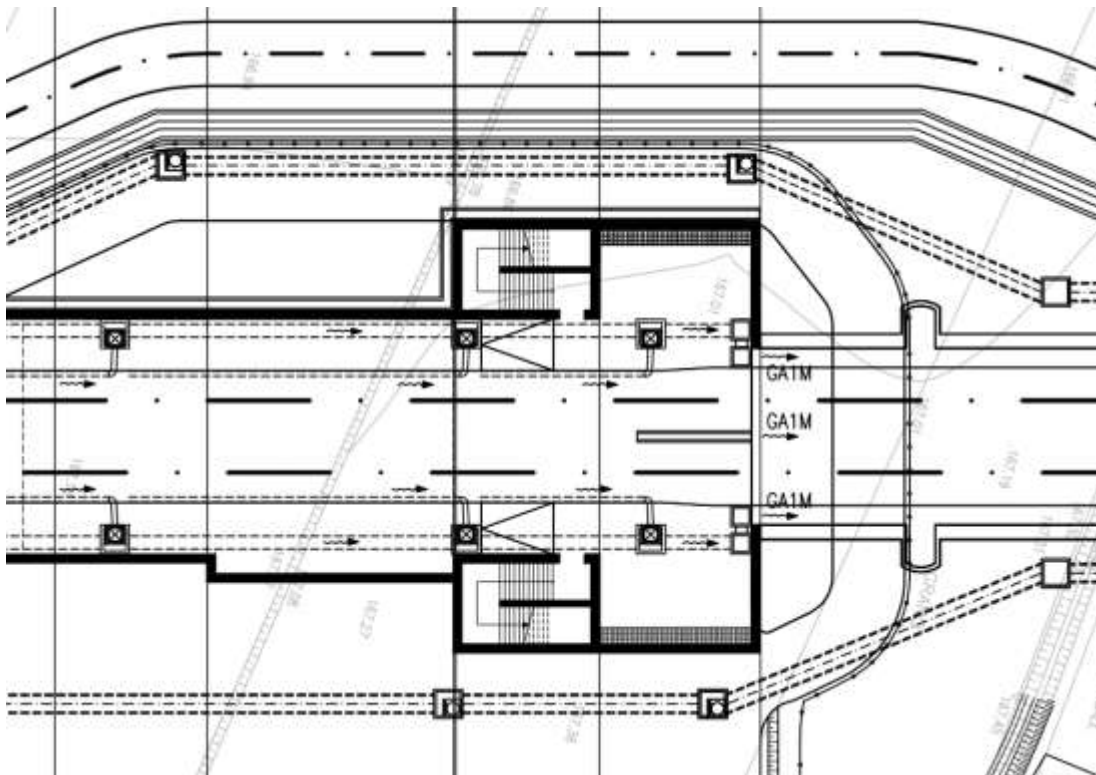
Ambito 10 – Pozzolo SUD Planimetria della configurazione delle nuove rampe di accesso alla linea.
